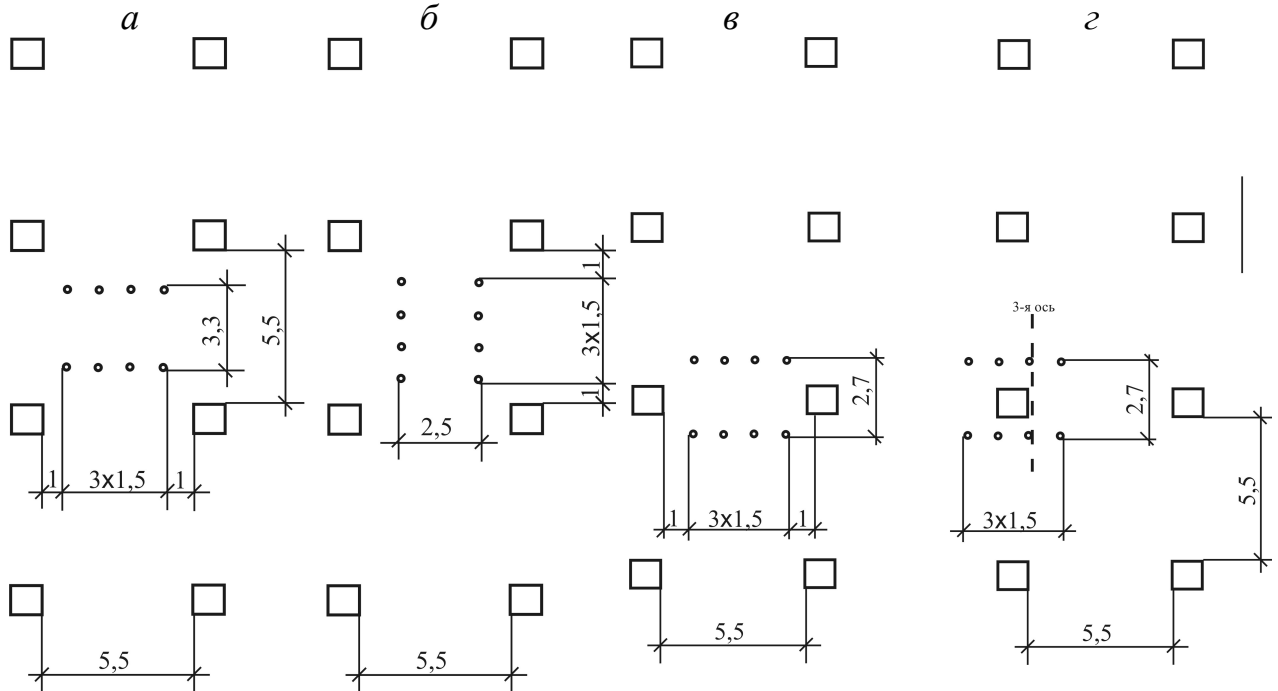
Схемы нагрузок модели: а) 2-я нагрузка; б) 3-я нагрузка; в) 4-я нагрузка; г) 5-я нагрузка
